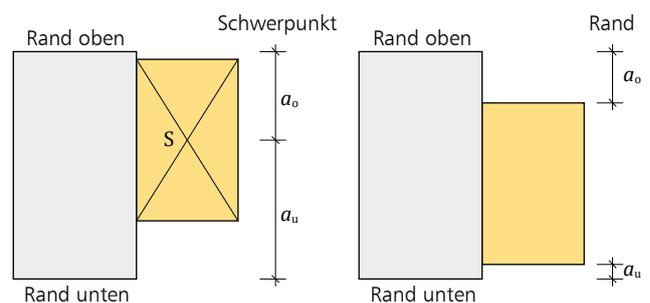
Positionierung mit Bezug Rand (Betonbauteil) zu Schwerpunkt/Rand (Holzbauteil)
